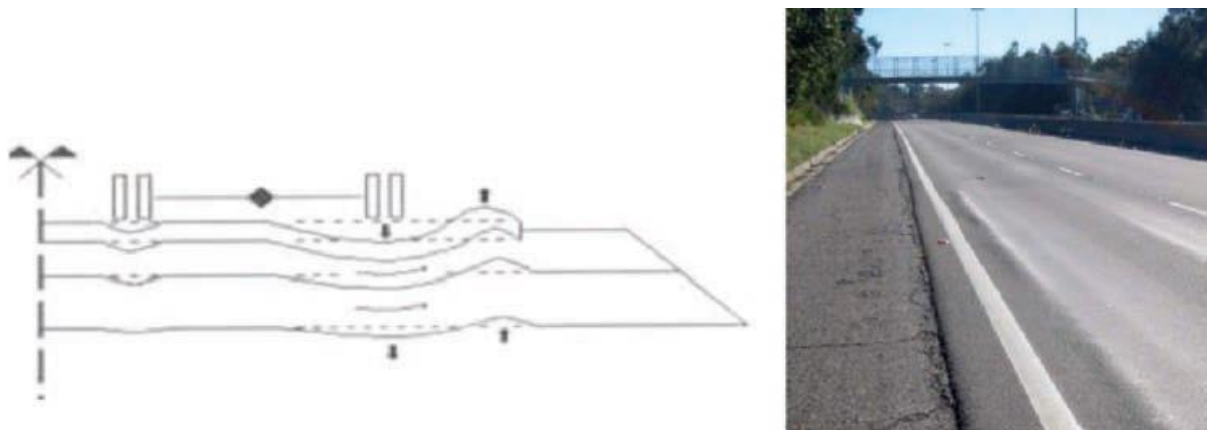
Mecanismo e foto de rodeiras com deformação plástica, em pavimento asfáltico. (ANE 2021)
